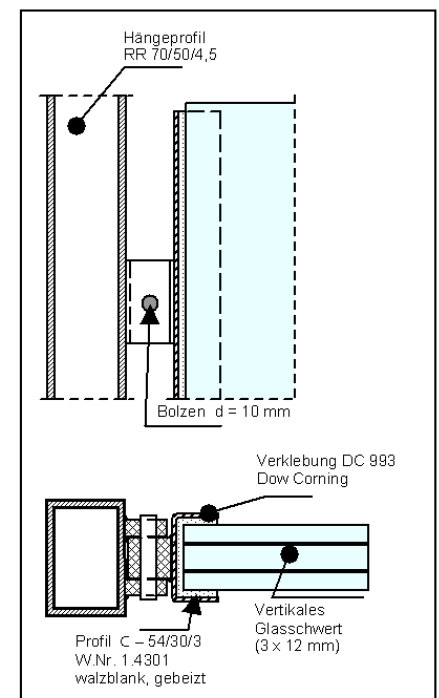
Detail Bolzenverbindung vertikales Glasschwert
